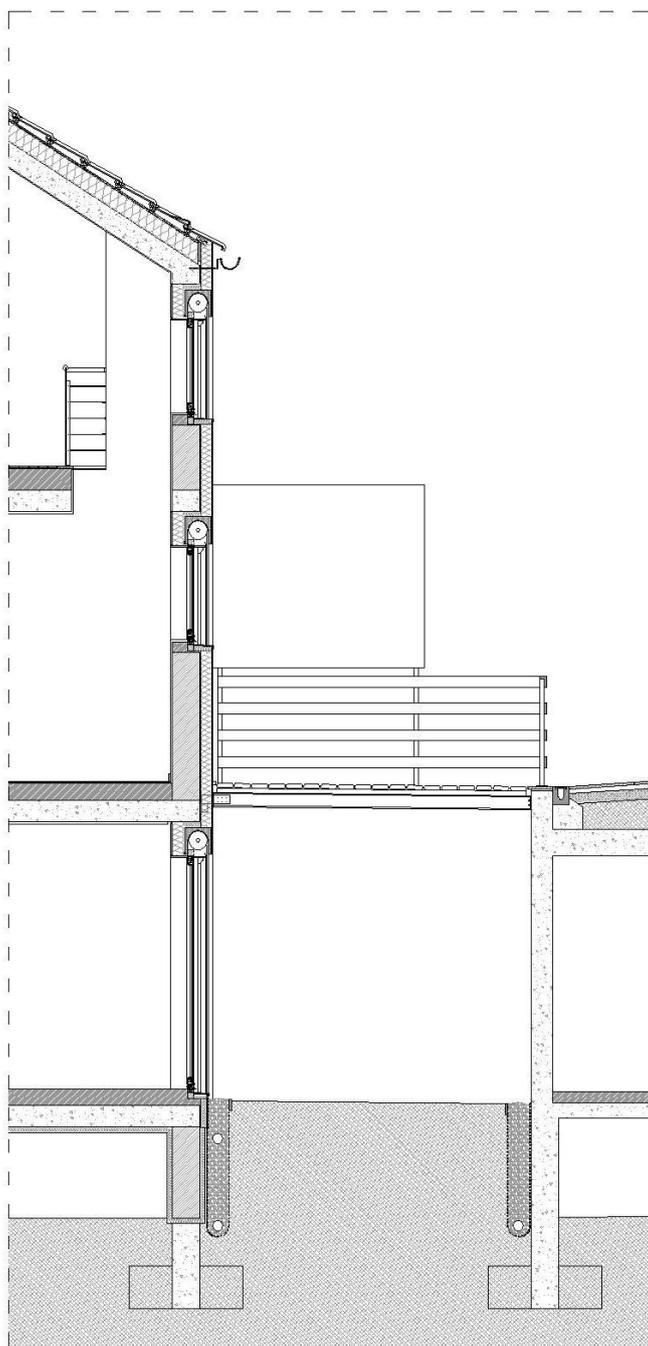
Corte construtivo da fachada (Fonte: Homegrid, 2012)
